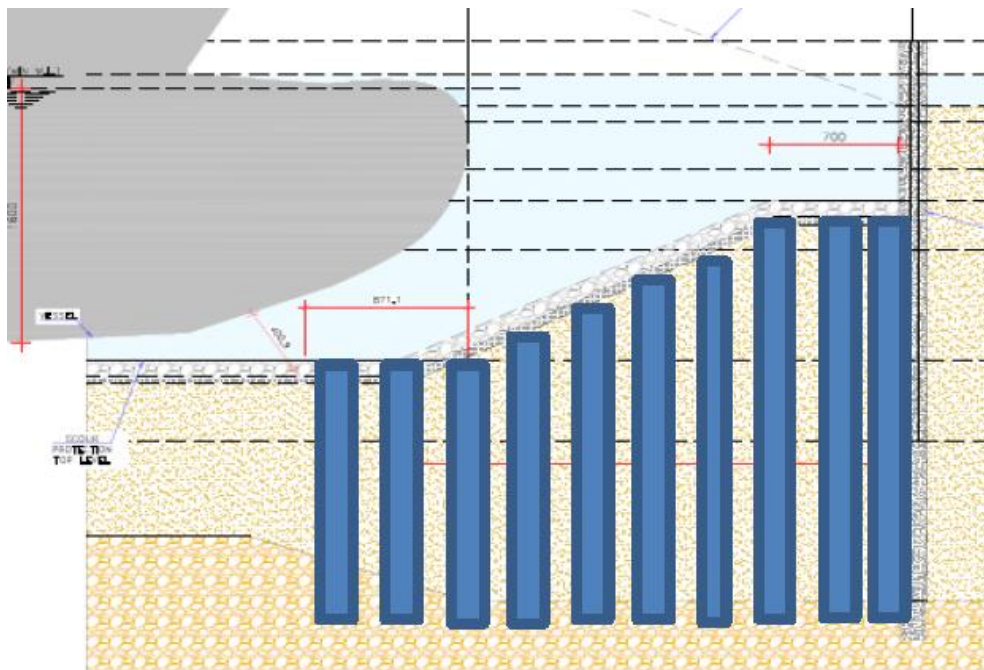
Protección del talud del muro combi-wall en la zona fuera de la playa de contenedores.
